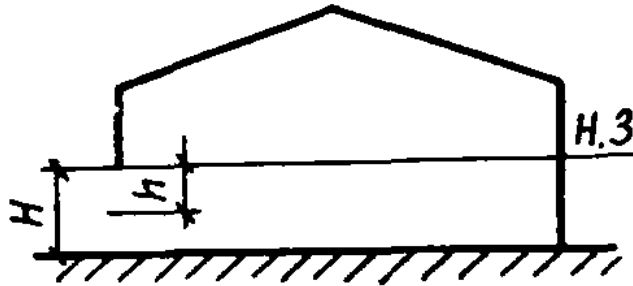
Схема будівлі, що обладнується повітряно-тепловими завісами
